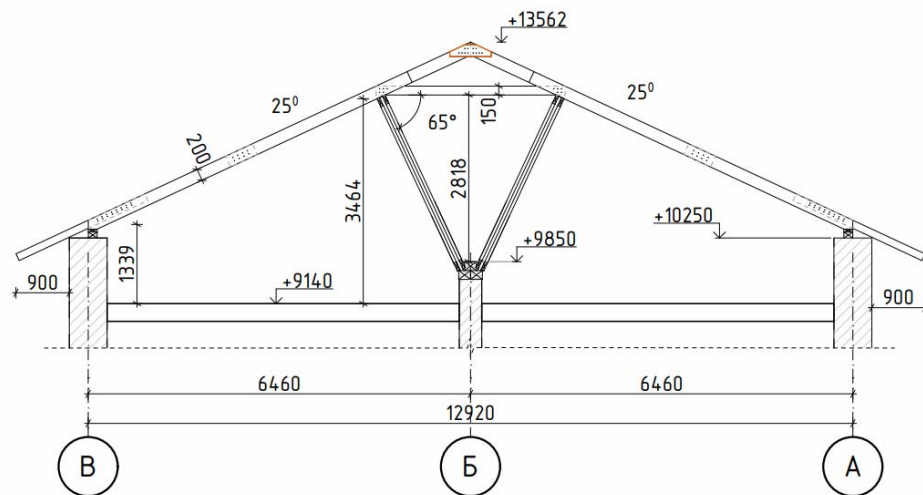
Поперечное сечение чердачного помещения жилого здания в Кондопоге
